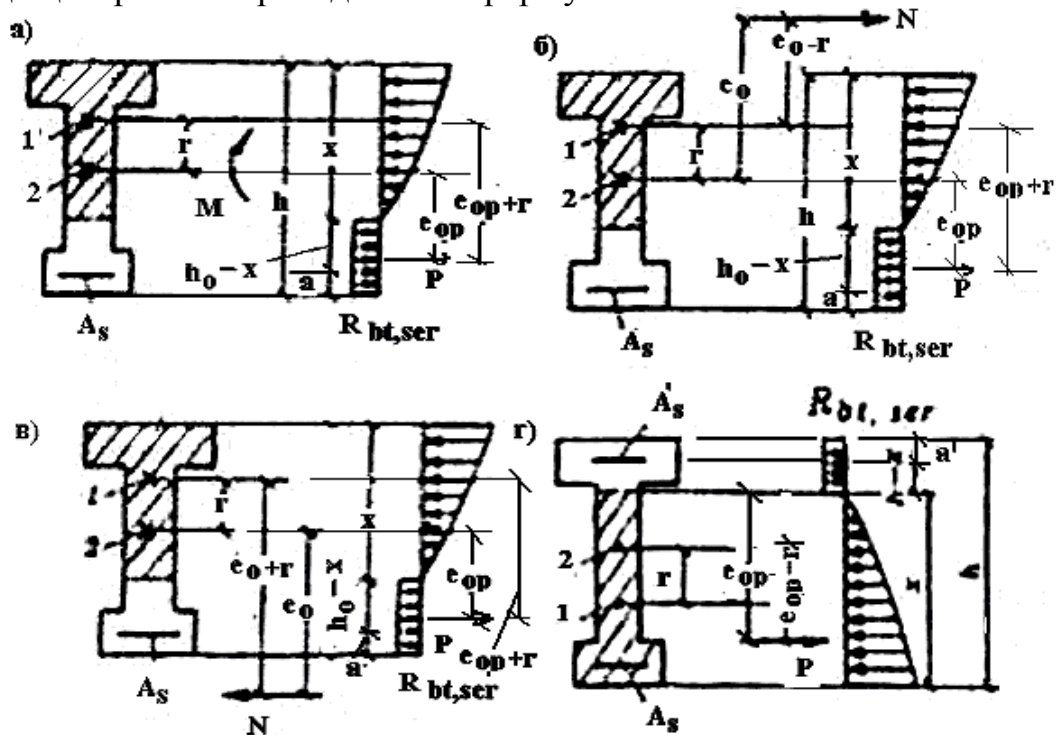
Схема зусиль та епюри напруження в поперечному перерізі елементу при розрахунку його на утворення тріщин, нормальних до подовжньої осі елементу: а – вигин, б – позацентрове стискання; в – позацентровий розтяг; г – обтиснення; 1 – ядрова точка; 2 – центр ваги приведенного перерізу
